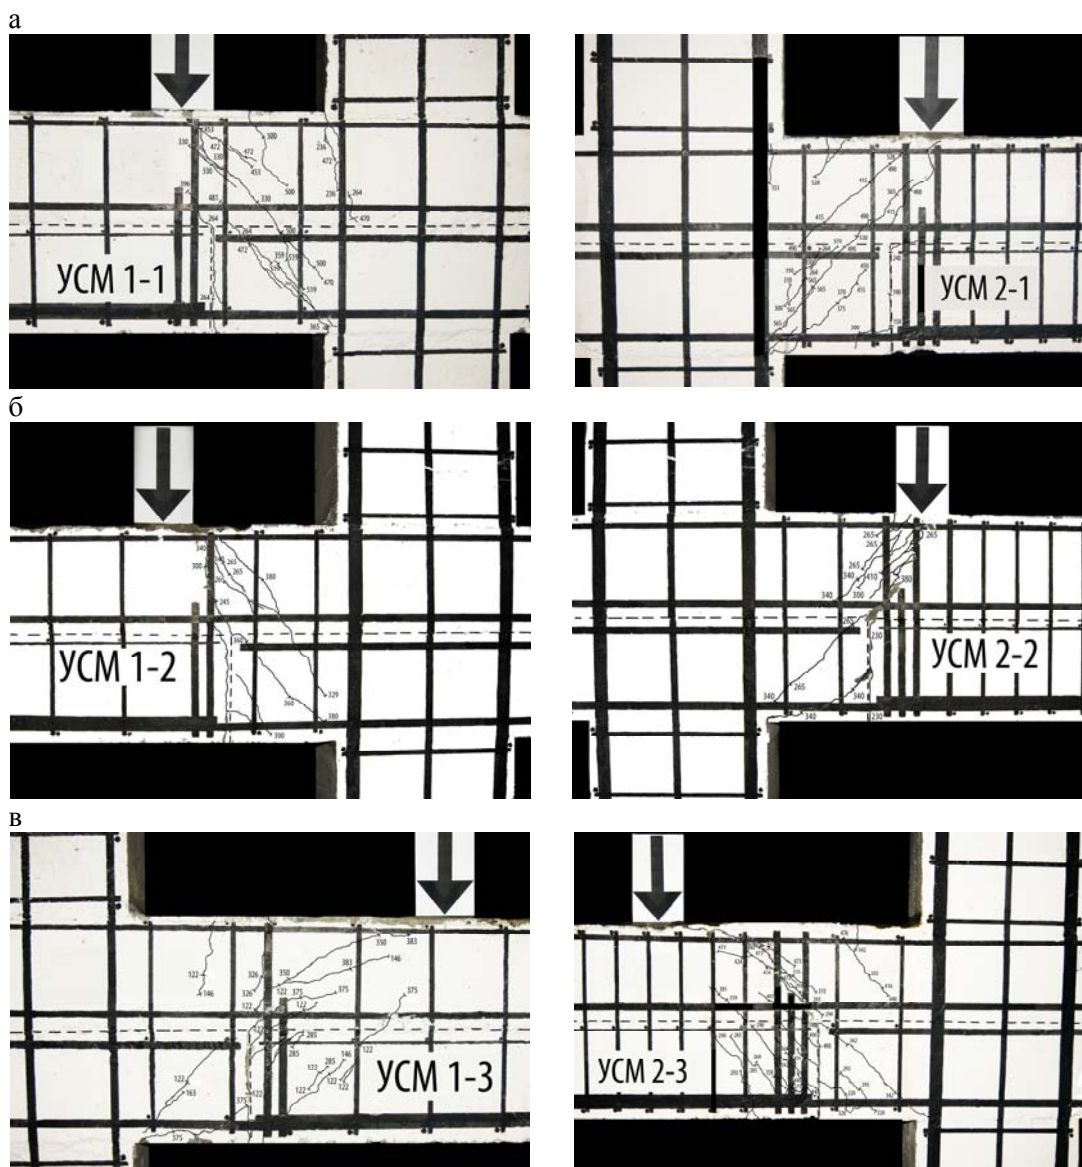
Схемы разрушения узлового соединения ригеля с колонной при пролетах среза:
